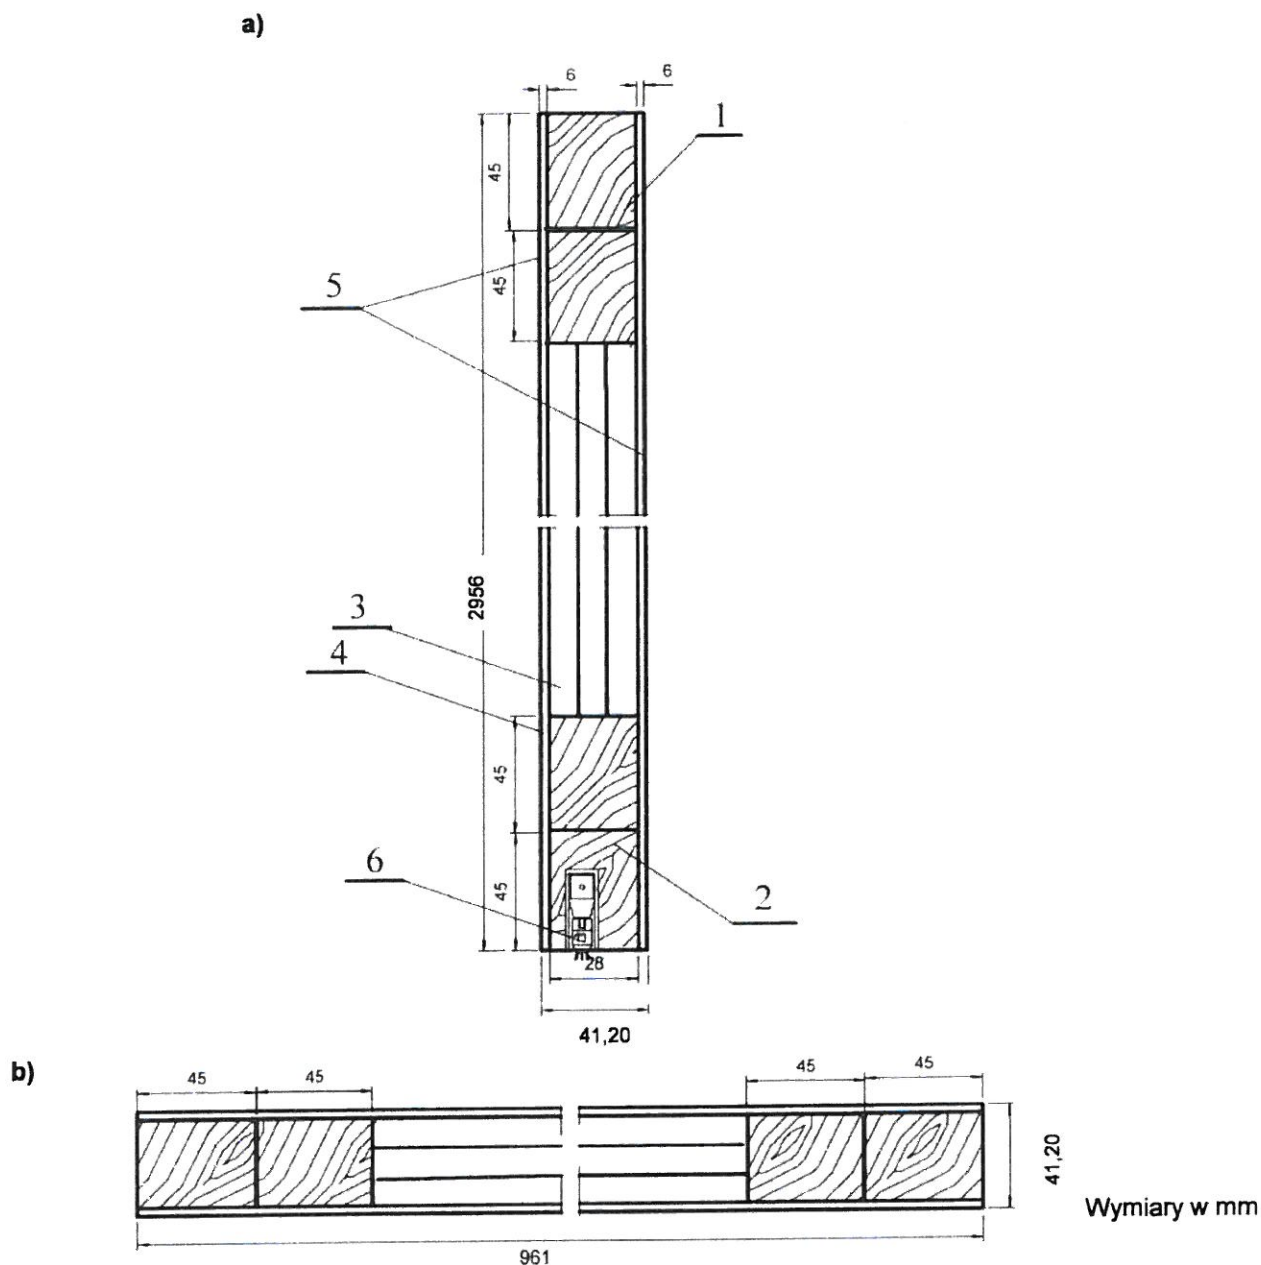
Konstrukcja skrzydła drzwi o oznaczeniu 37
